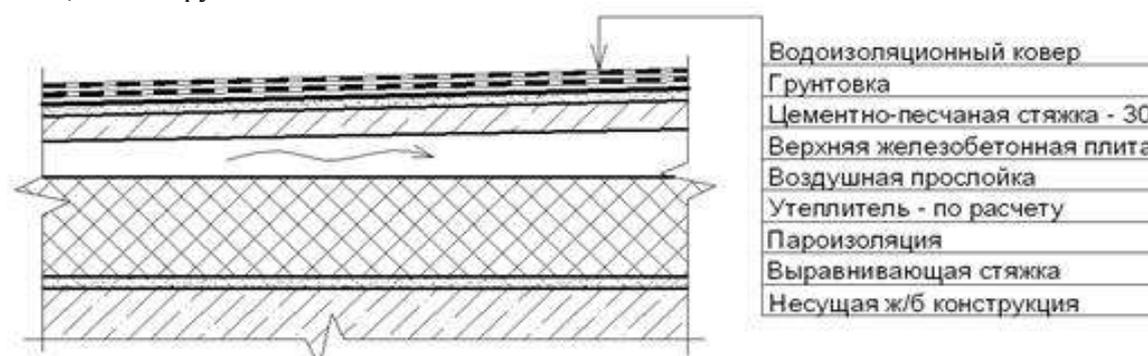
Состав кровли по несущей железобетонной конструкции 2
